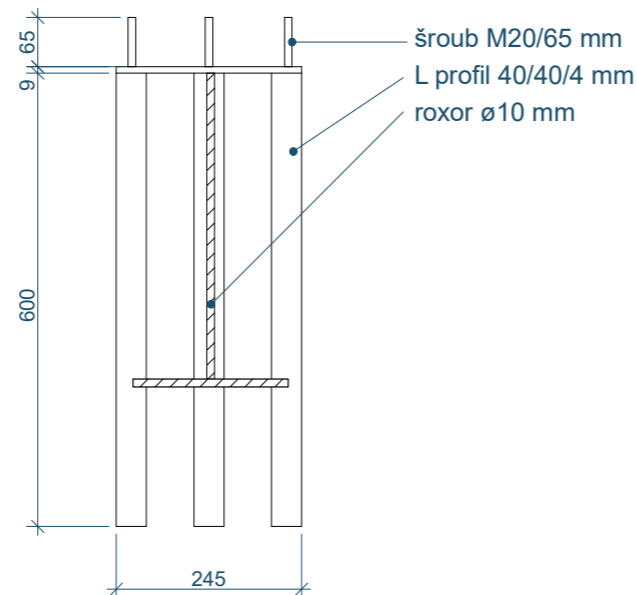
DETAIL KOTEVNÍHO ZÁKLADU LAMPY
